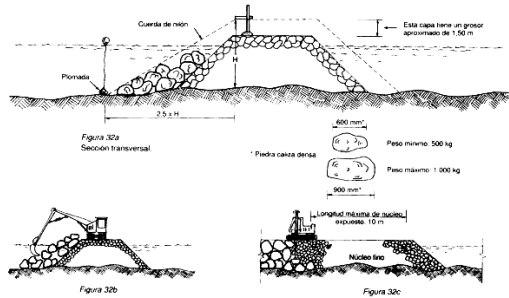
Fase inicial del vertido de piedra para la cobertura del núcleo fino.
